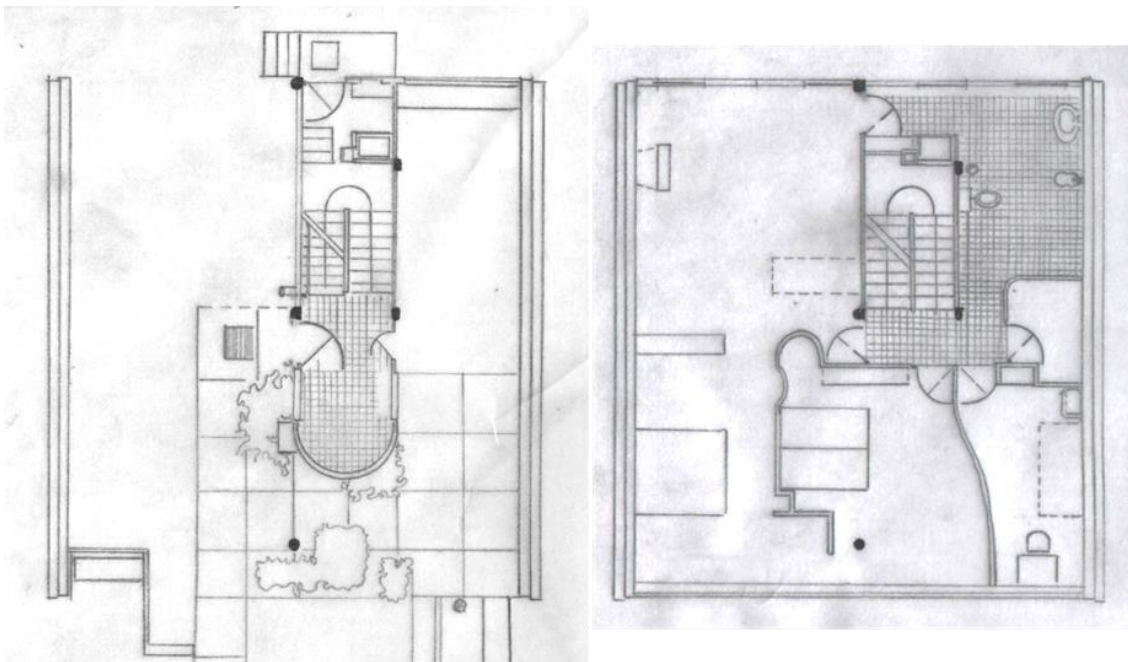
Grundriss im EG (links) und im 2.OG (rechts) [27]
